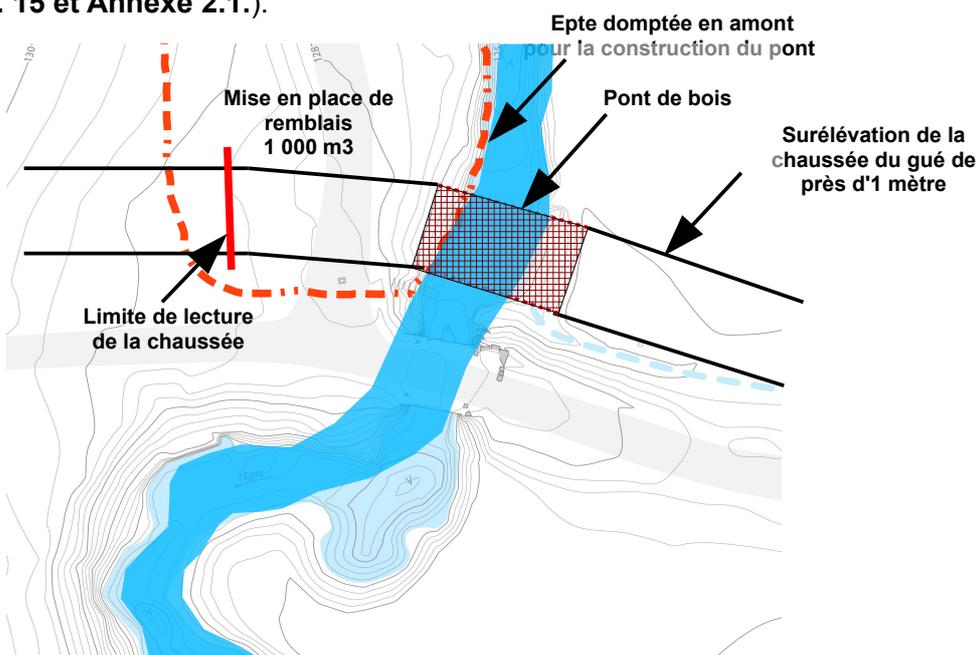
Hypothèse d'évolution du site de Pont de Coq - Construction d'un pont de bois
